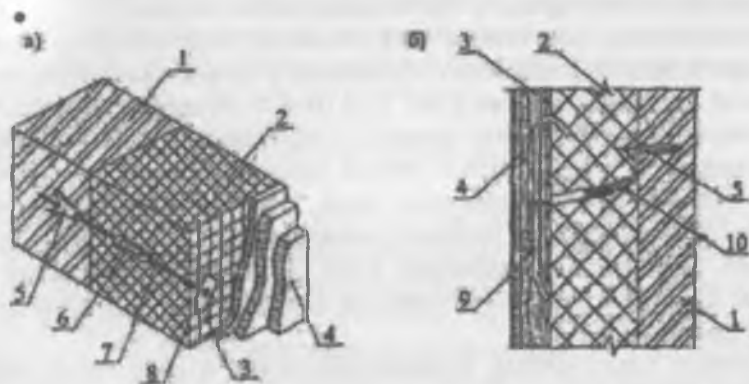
Система утепления стен с оштукатуриванием в три слоя:
